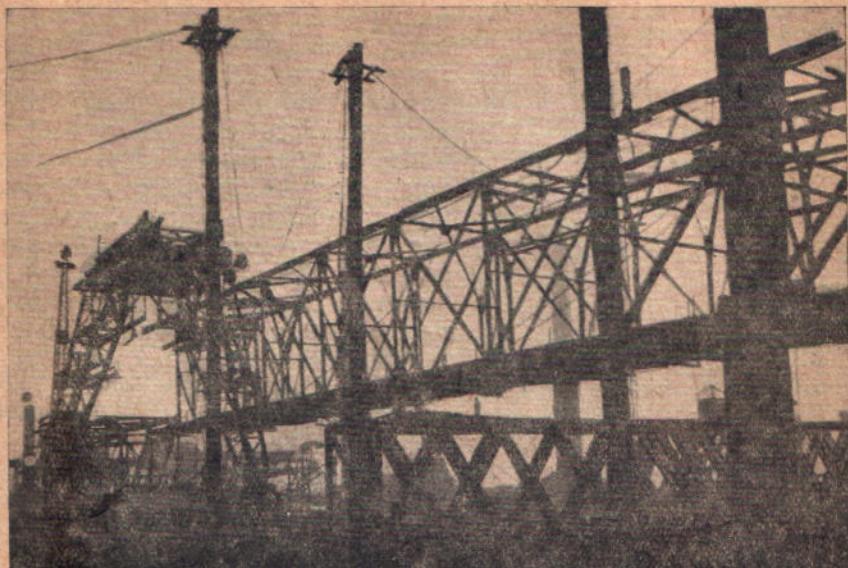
в. Вид моста, поднятого до соединительных узлов на опорах
